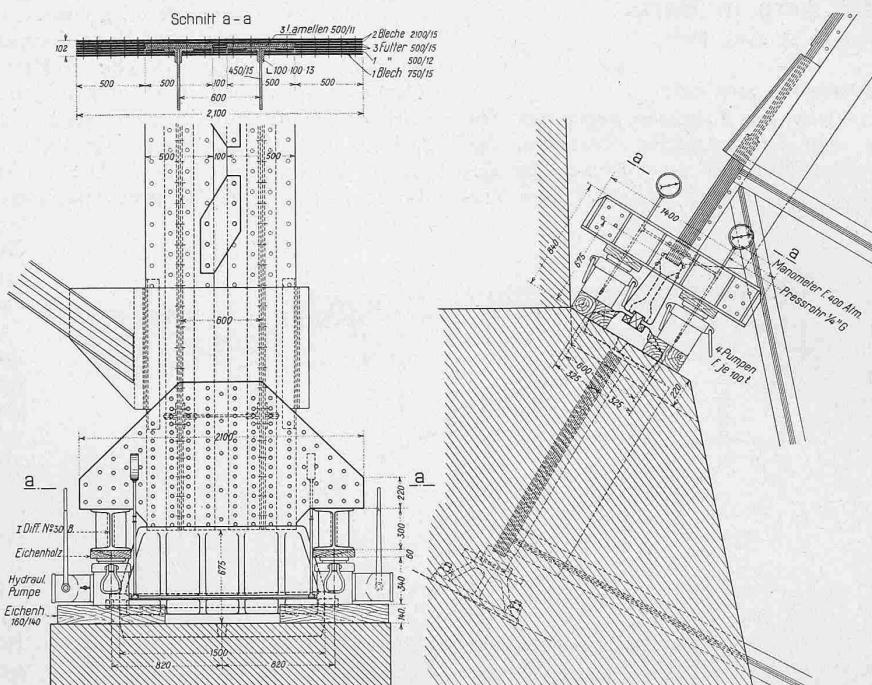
Vorrichtung zum Einstellen der verbesserten Drucklinie und Einbau des neuen Lagers C. — Maßstab 1:50.
